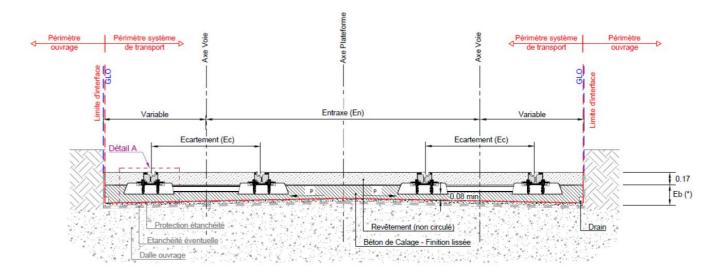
coupe type d'une plateforme - Voie béton traverses – Sans béton de fondation sur ouvrage
